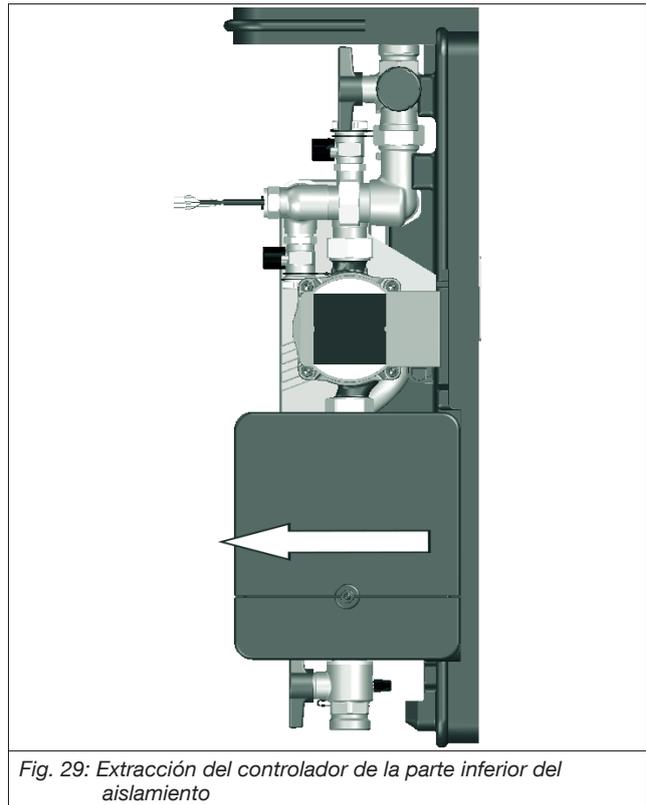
Extracción del controlador de la parte inferior del aislamiento
